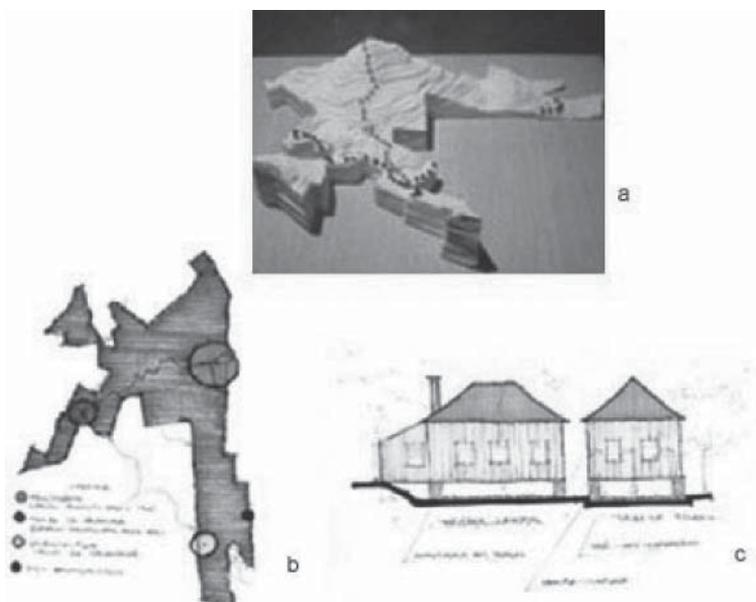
a) maquete de estudos; b) croqui de estudo da área do parque; c) croqui de edificação existente no parque
